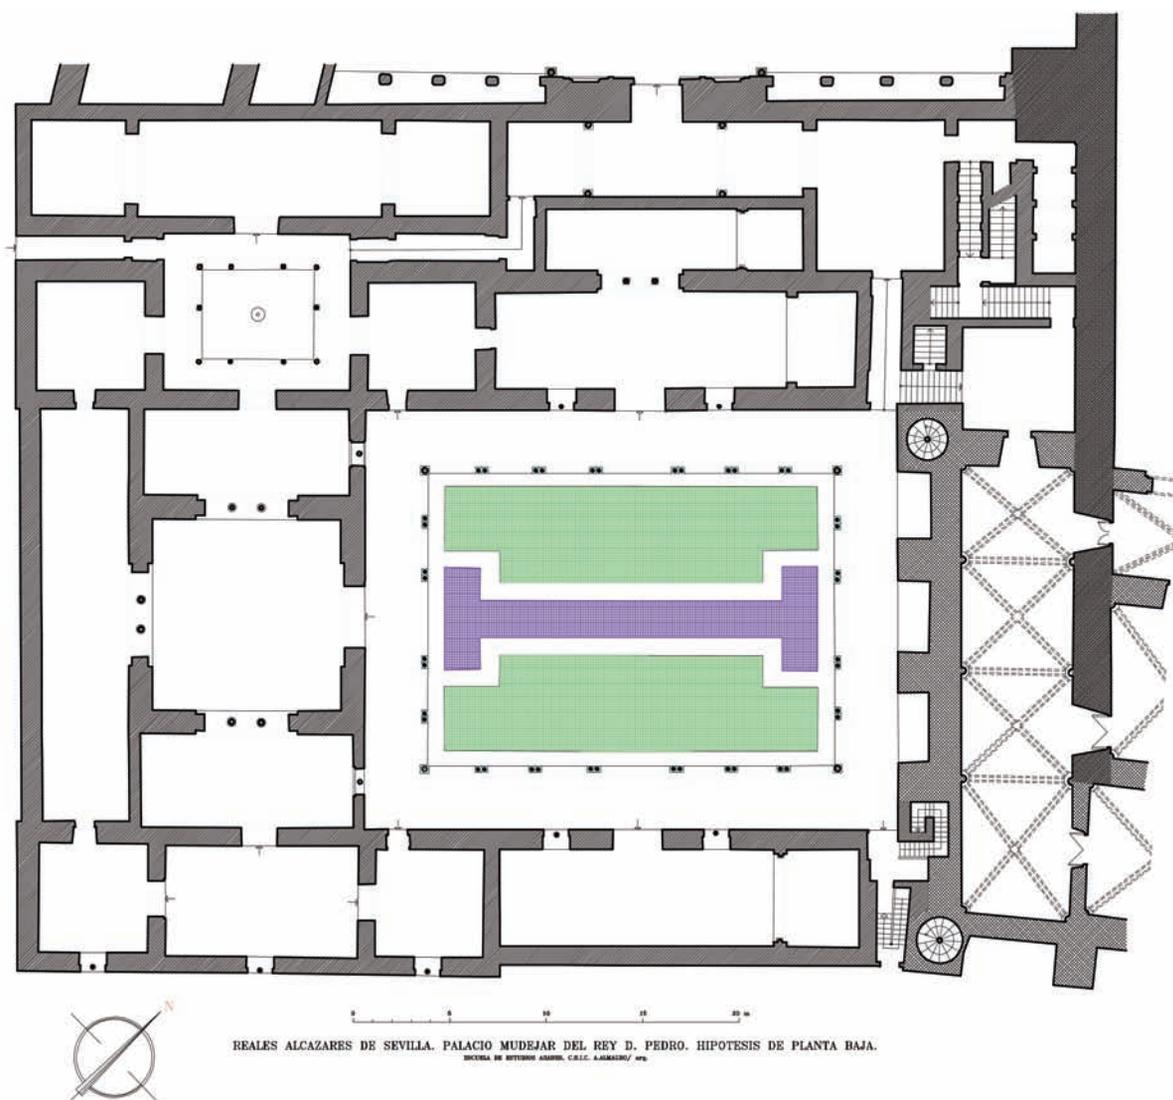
Planta baja hipotética del palacio de Pedro I (A. Almagro).
